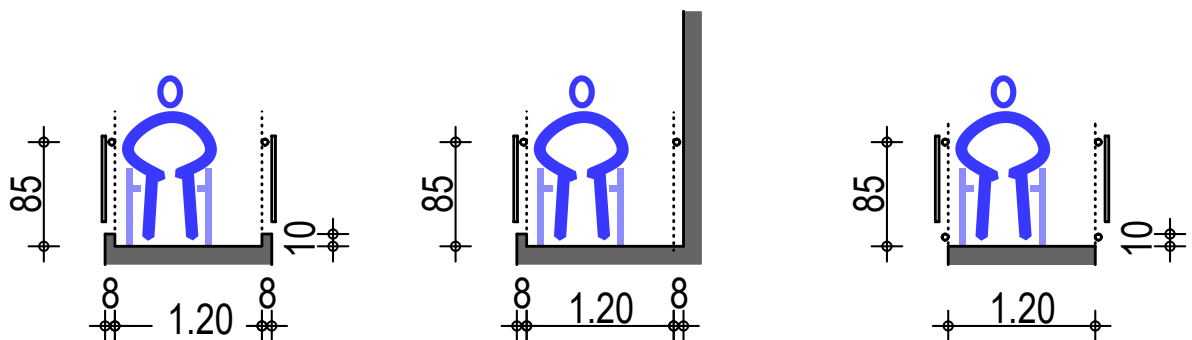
Maßangaben zu Rampenanlagen – Querschnitte
